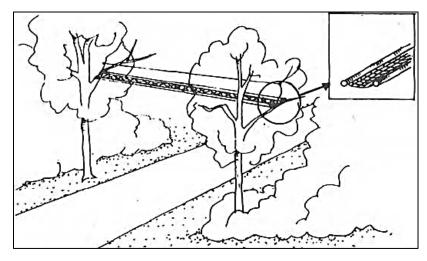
Paso compuesto por una plataforma de red suspendida mediante dos cables de acero (Ref. 8)
